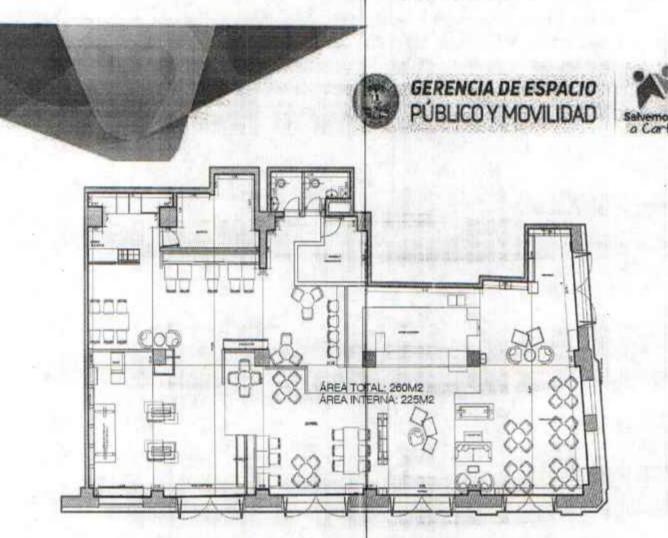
Plano CAFÉ SAN ALBERTO - Área privada.
